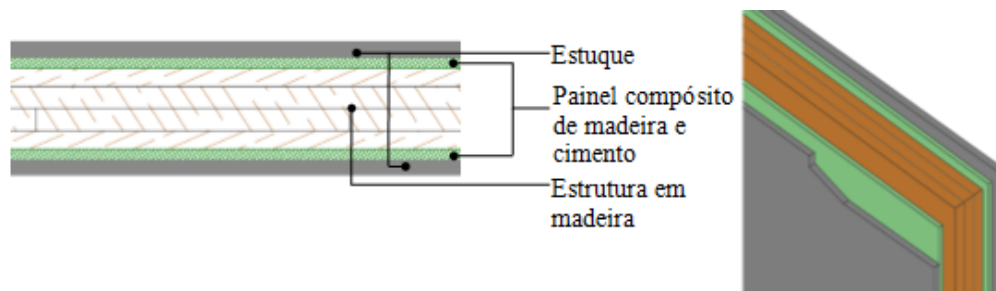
Esquema da solução 1 de parede interior (corte horizontal) e modelo em 3D
